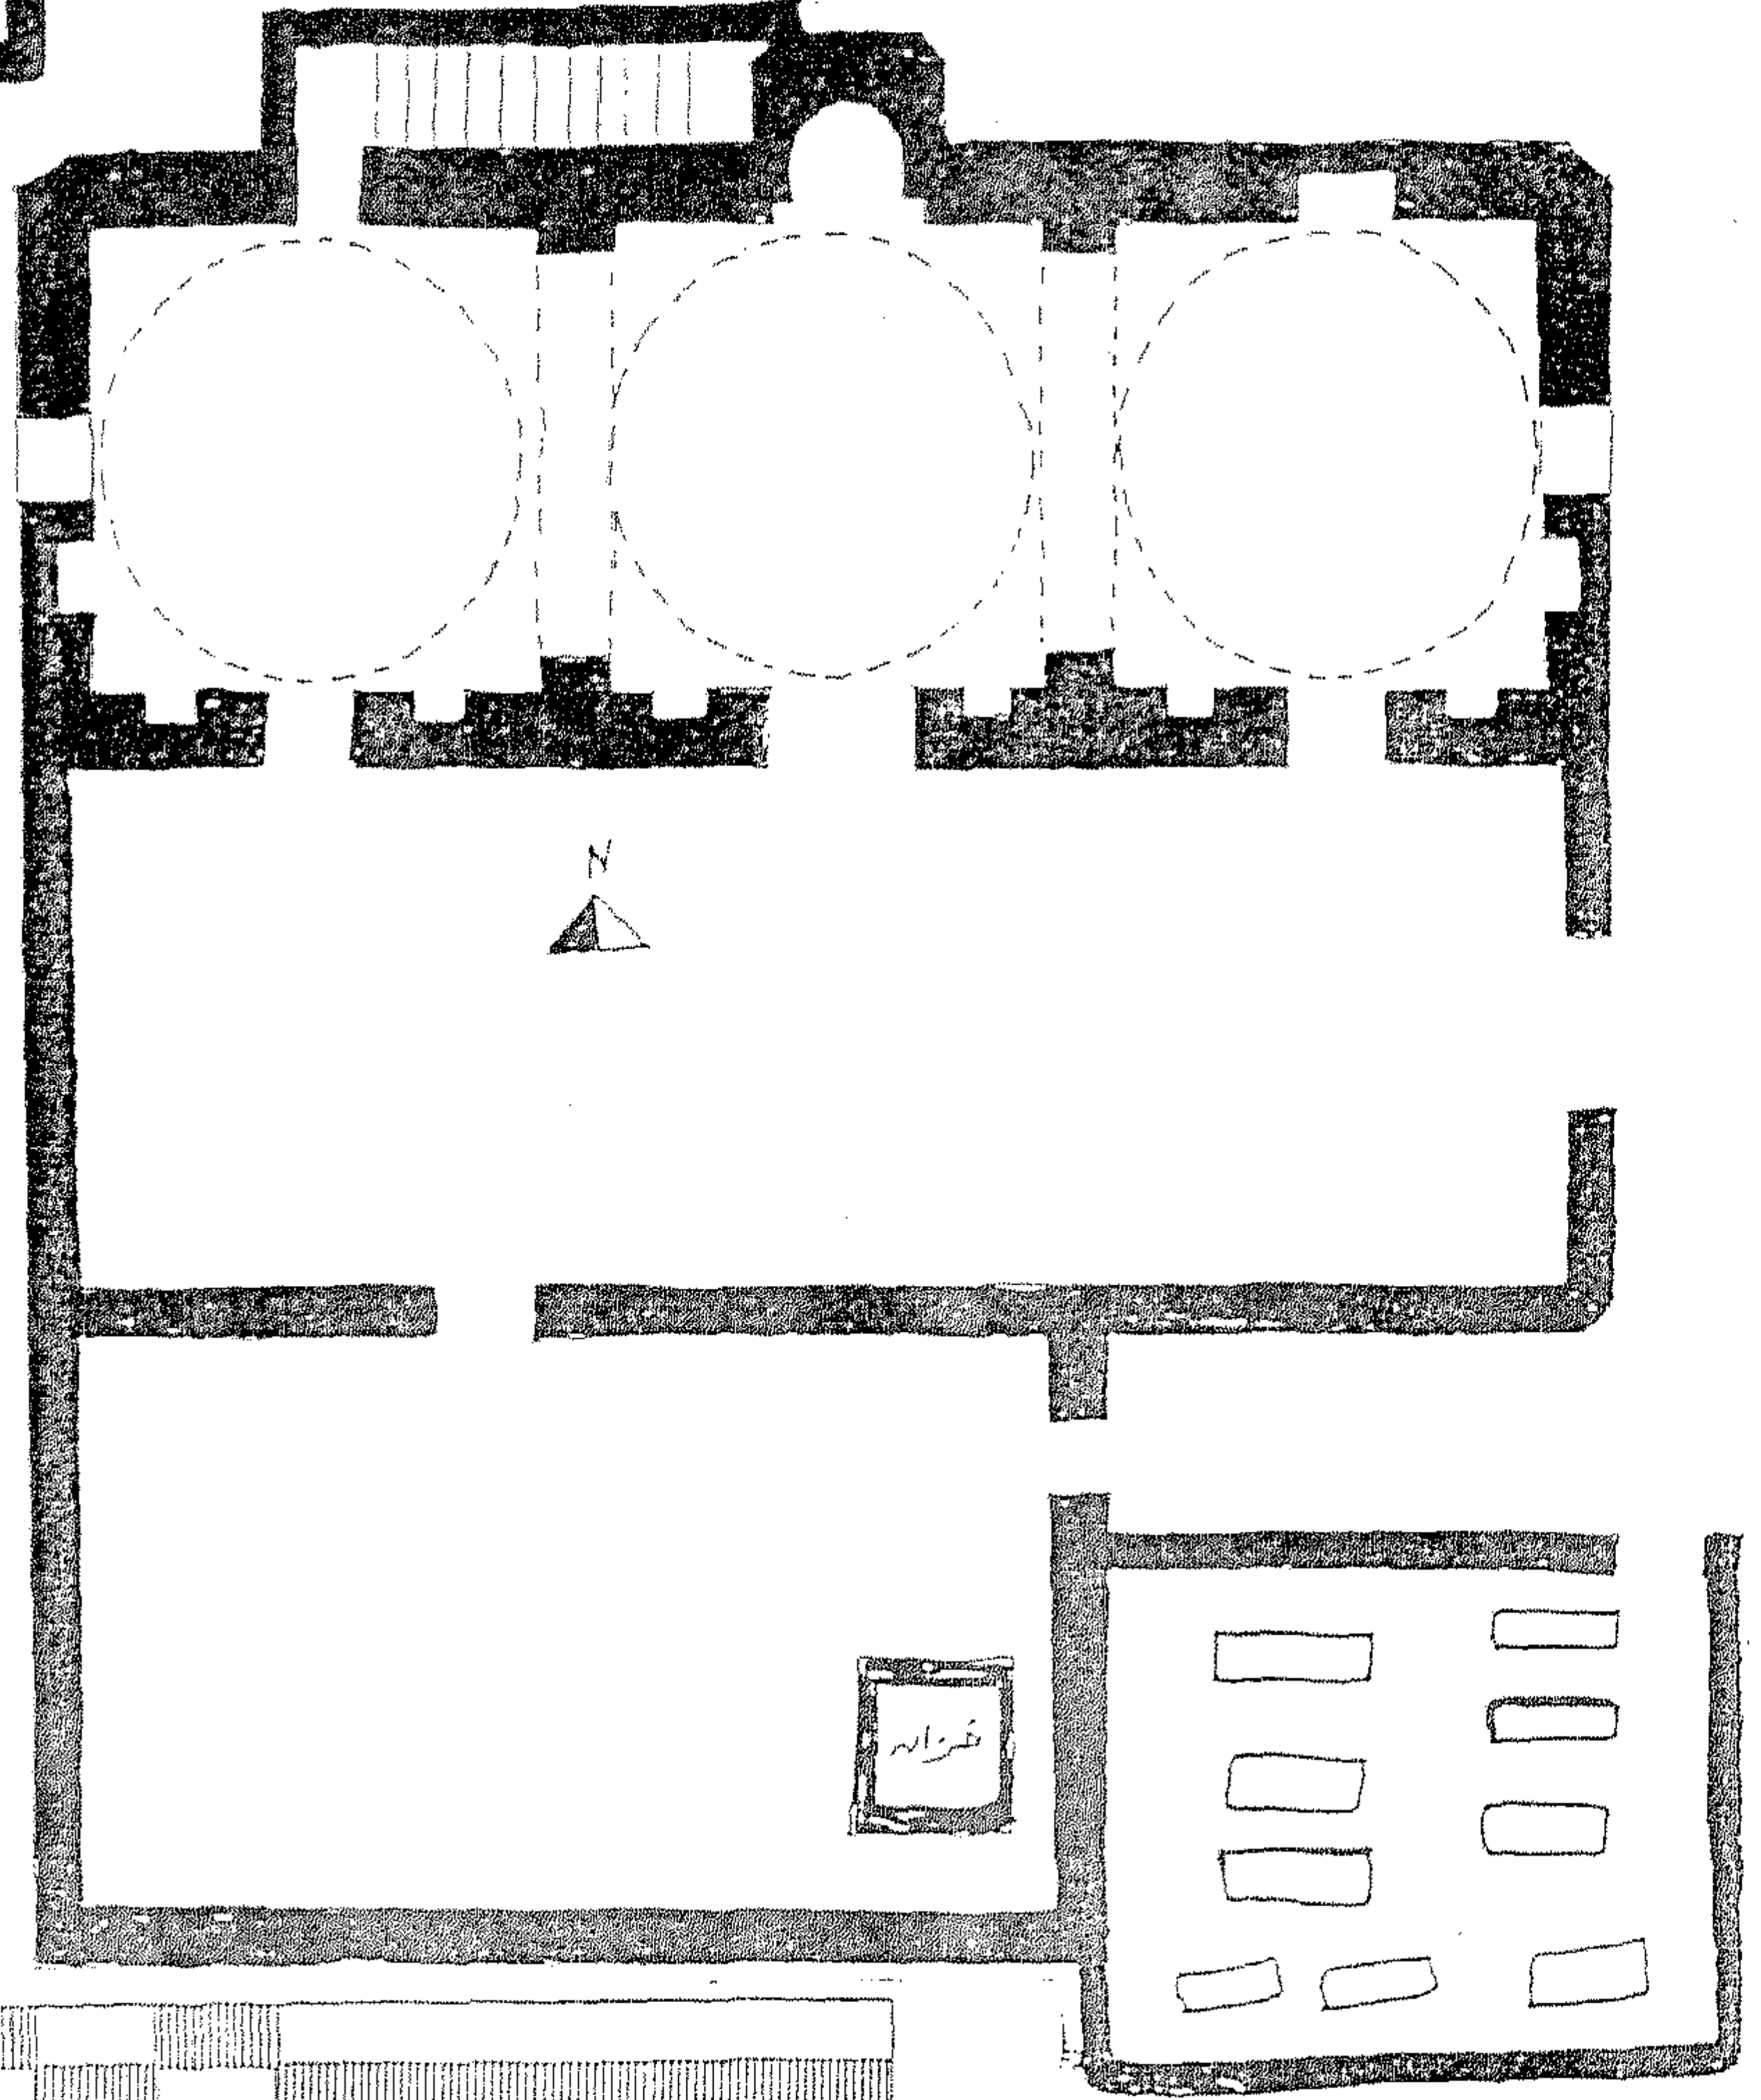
حيس ، مسجد ابن أبي الخل ، المسقط الأفقى
